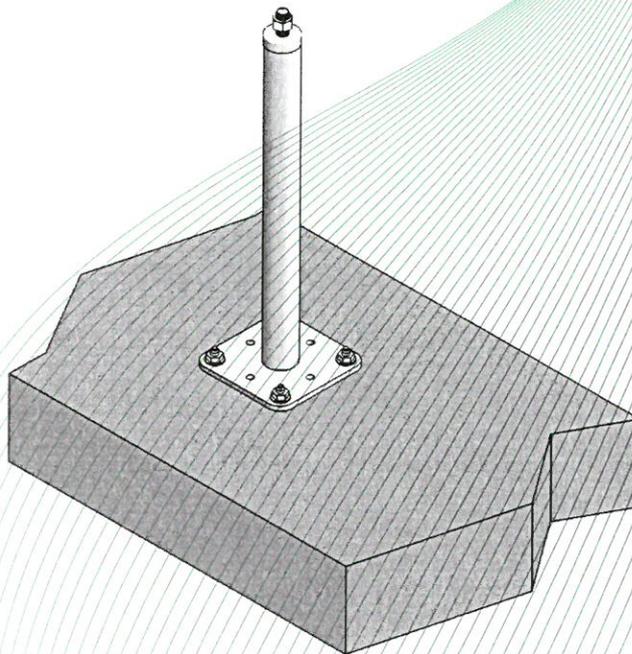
Anschlageinrichtung, Typ: SAFEX VARIANT montiert auf einem Betonuntergrund
